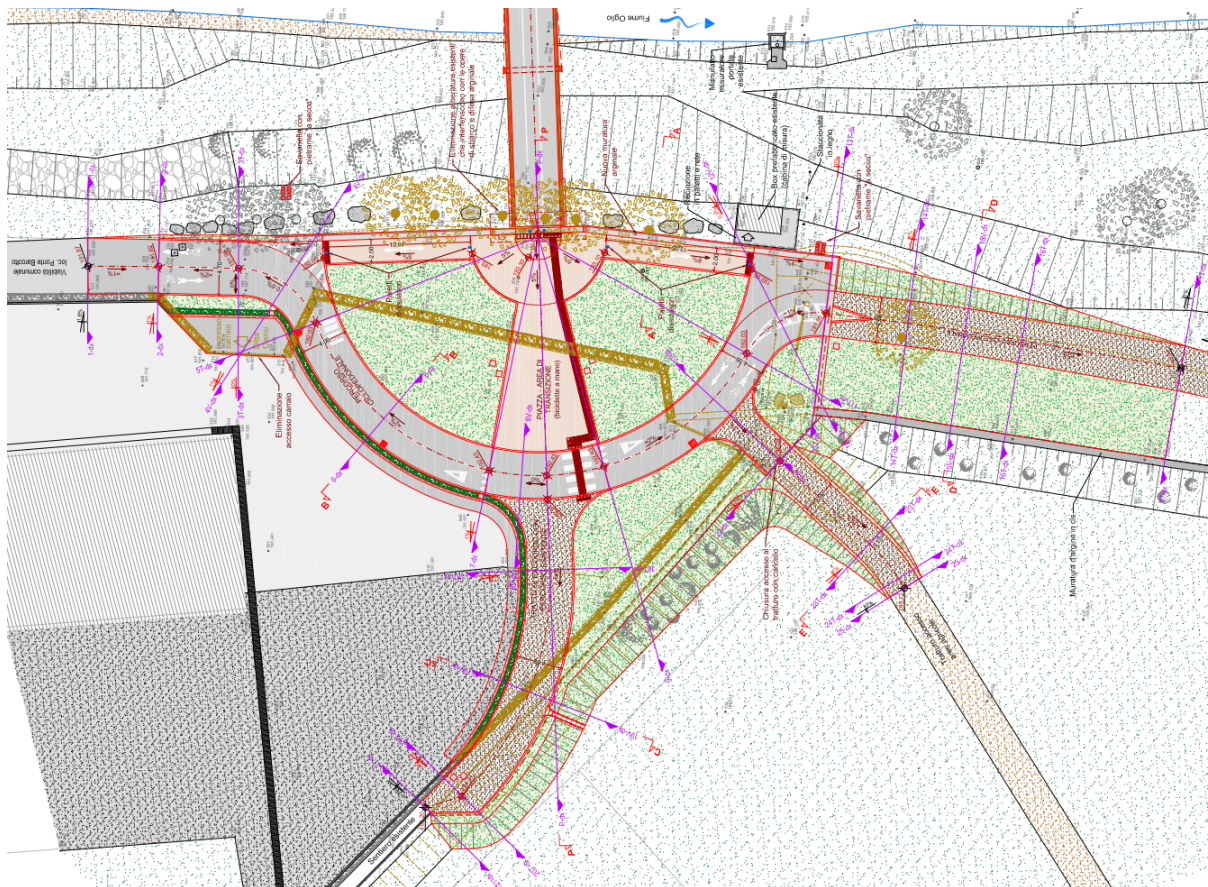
Stralcio planimetrico dei percorsi di accesso al ponte in sponda destra e della piazza.
